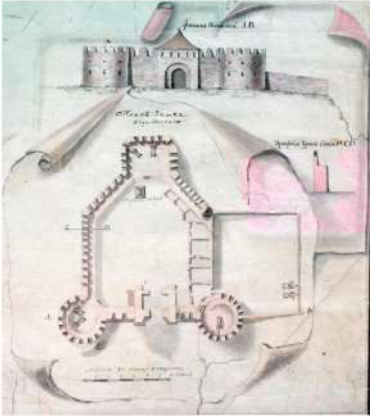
План плану Гаджибівського замка 1789 р. Фасади і креслення замка. Фрагмент [61].
